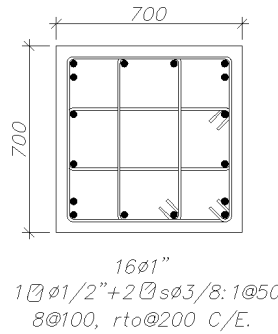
Detalle de refuerzo de columna C-1, ubicado entre los ejes 3 y F del primer piso.
